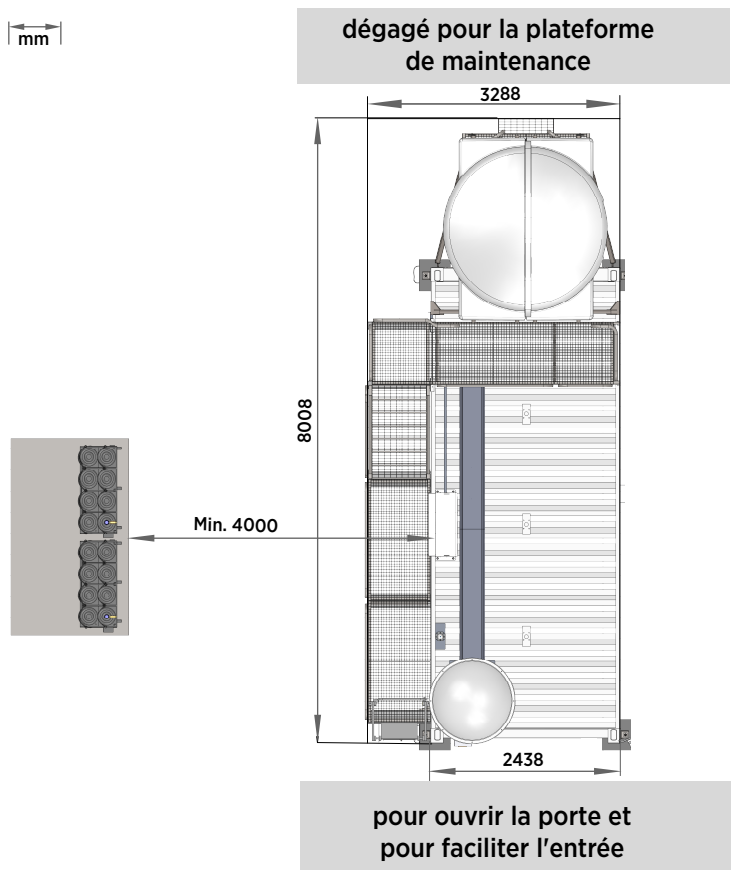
Aménagement du site de l'AUTOSONDE pour la planification des clôtures
